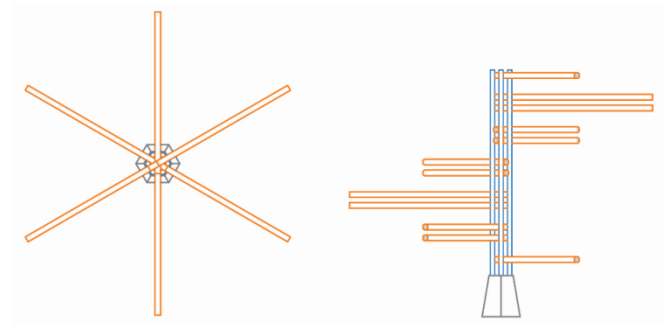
Vista en planta y alzado de los elementos estructurales principales
